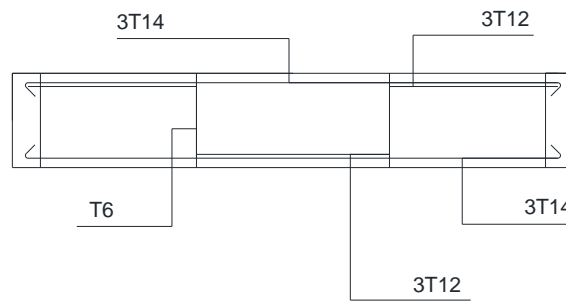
Coupe longitudinale d'une poutre secondaire 20x30cm (bâtiment R+10)
